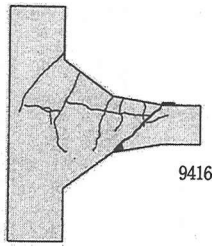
TYPE-IV②試験体(ハンチが対称)のひび割れ発生状況
